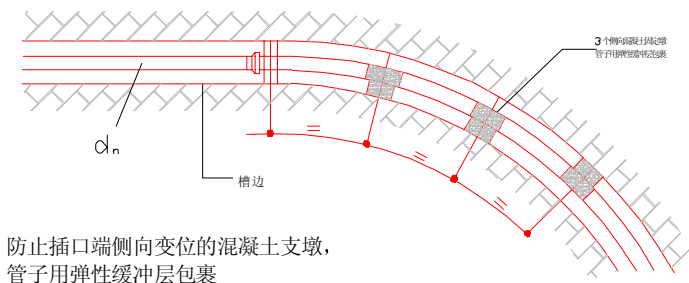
冷弯曲敷设 PVC-U 管的固定墩
